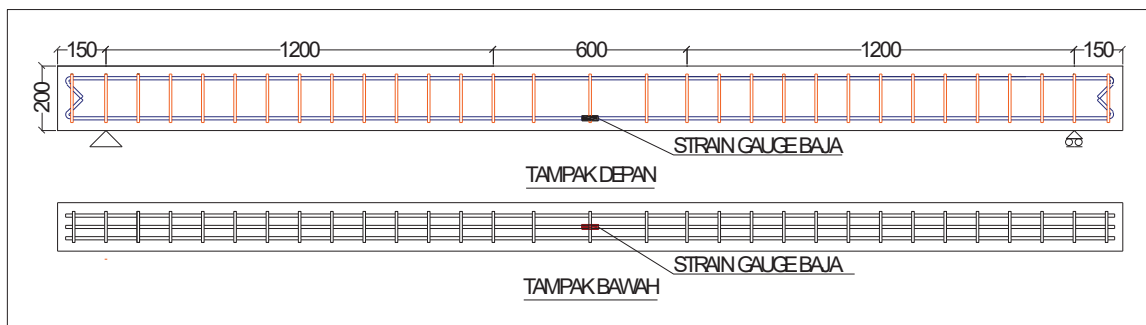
Detail benda uji – BGS (Balok Grouting Sandblasting)
